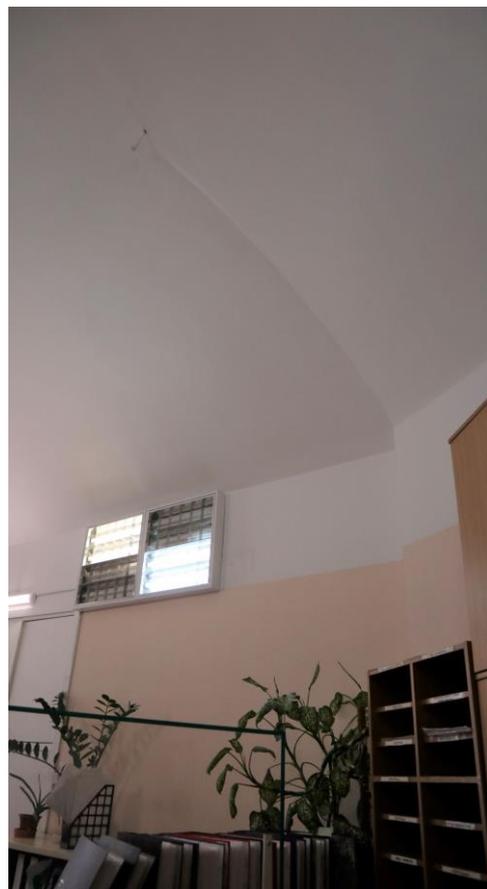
, 80. 1 этаж, офисное помещение 10Н (6).
